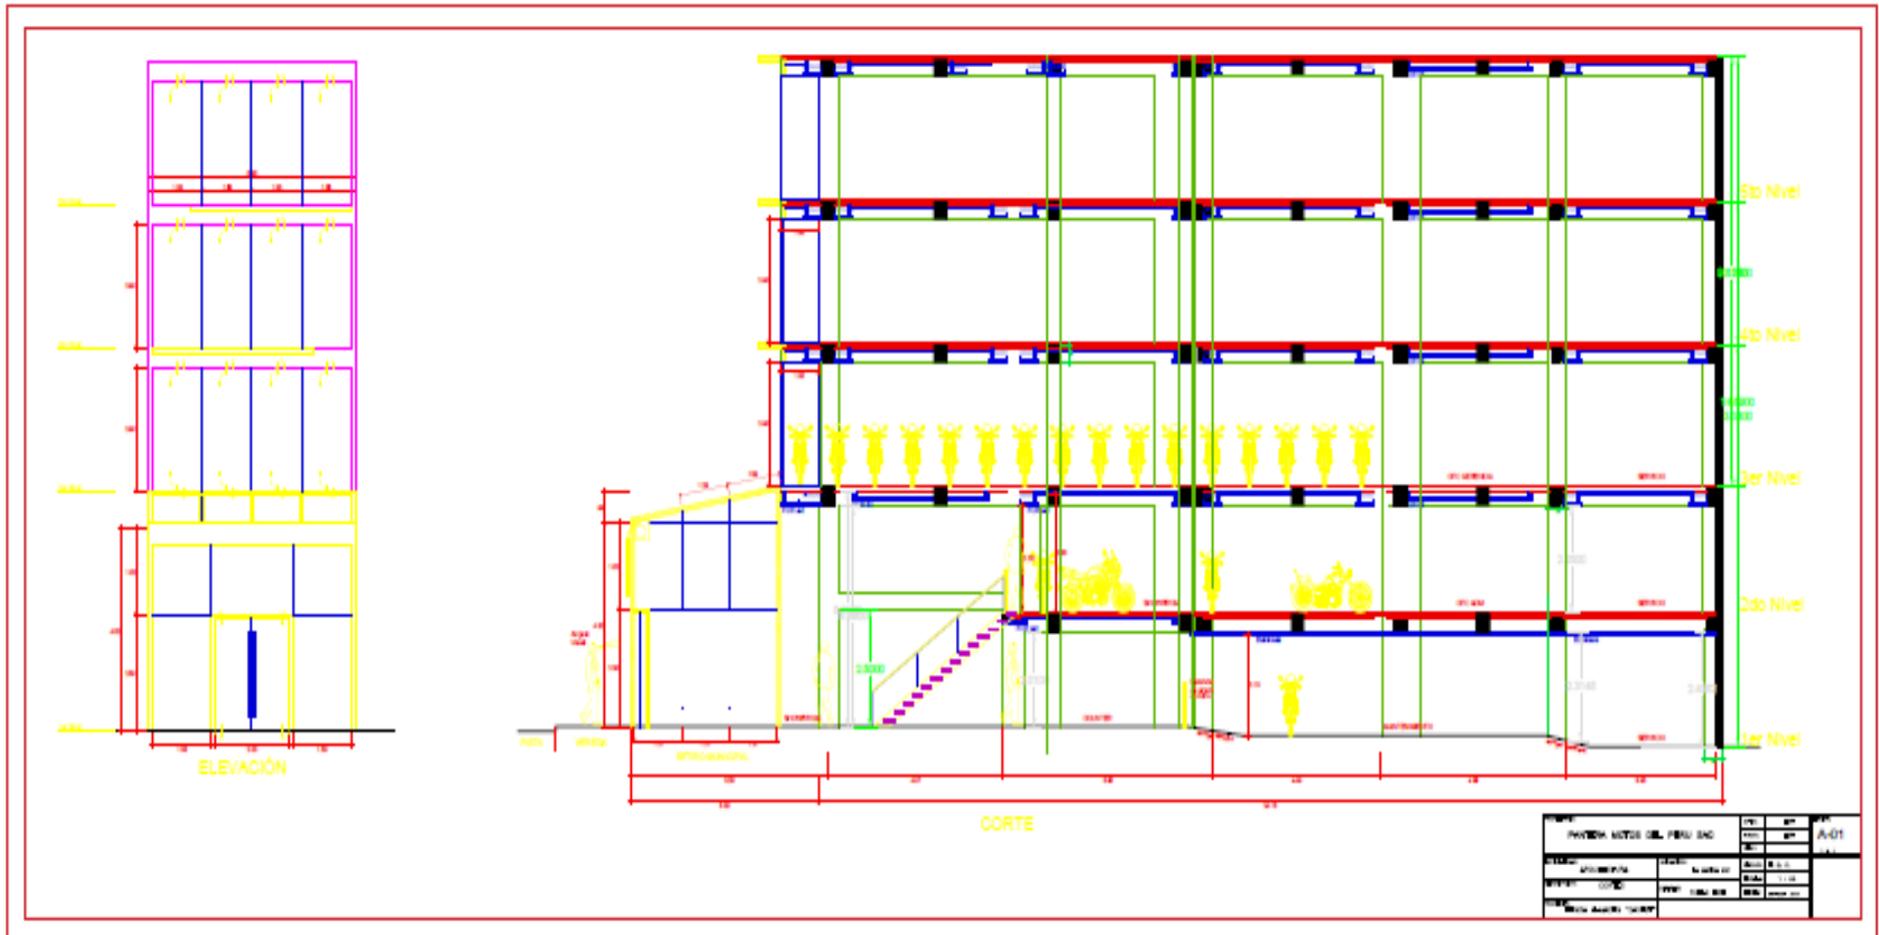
PLANO DE DETALLES DE ESTRUCTURA
